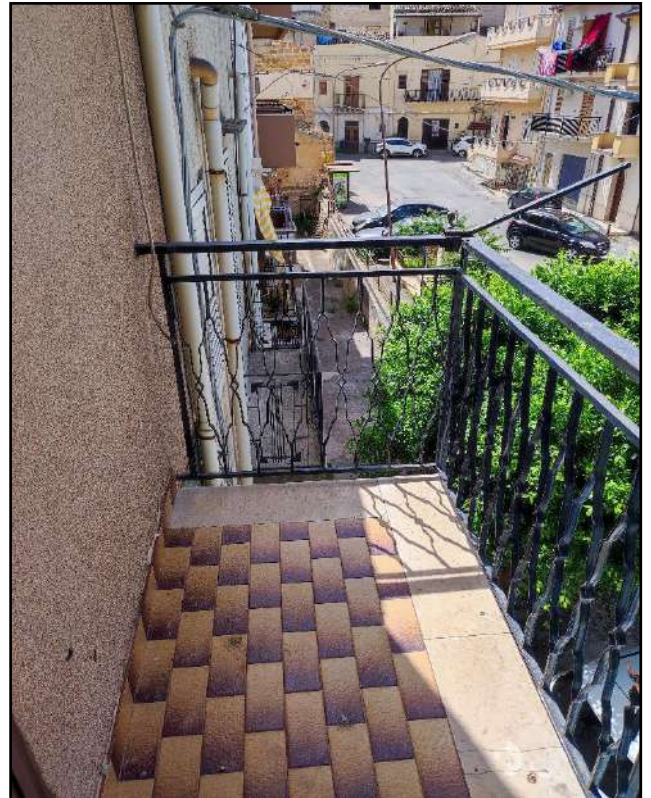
Camera 1: balcone prospiciente Largo Villa Migliore
